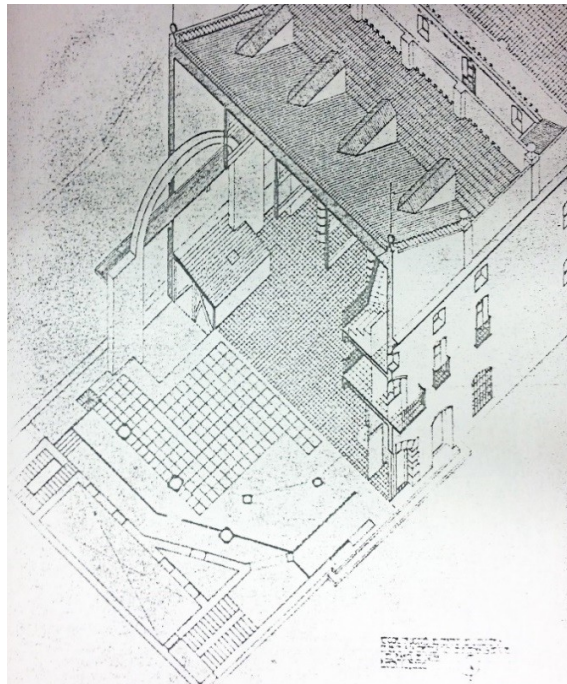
Reconstrucción del Teatro de la Olivera en base a la capitulación de 1618 y el plano de 1678. Axonometría. [3]
